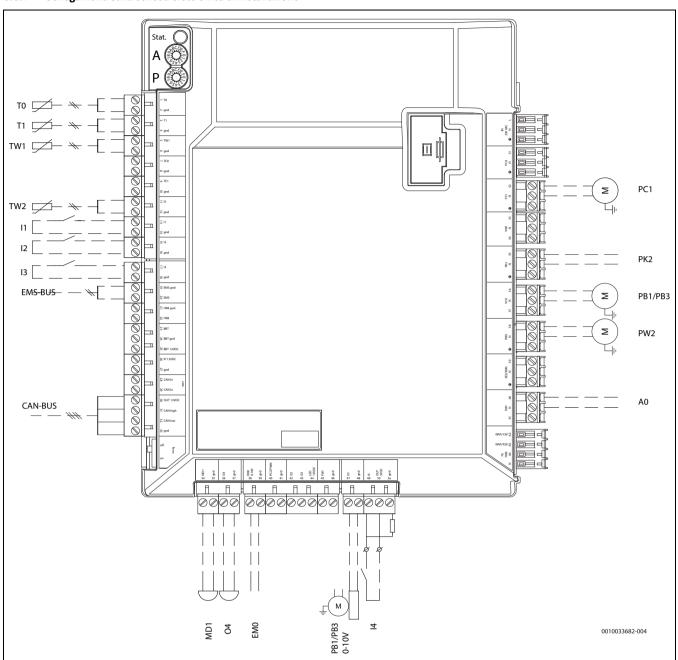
Collegamenti sulla scheda elettronica di installazione
